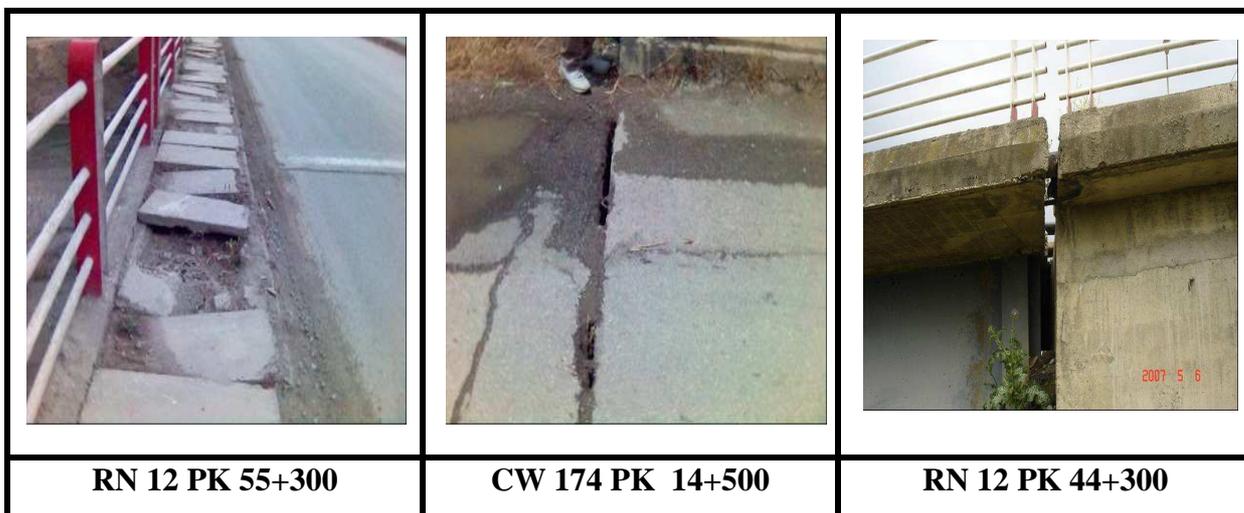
Défaut présente aux niveaux des joints de chaussée.
